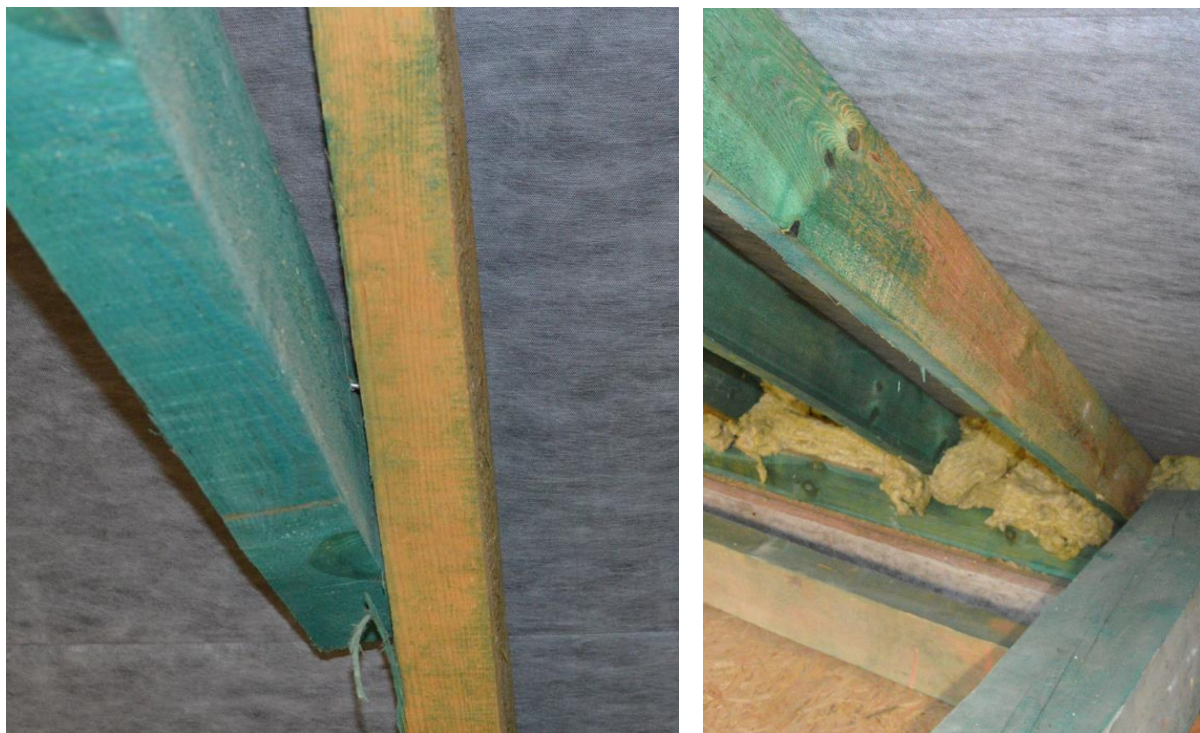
Płatew pośrednia - przekrój o krawędzi zaokrąglonej: nieprawidłowe przygotowanie elementu do wbudowania w obiekcie budowlanym [1.3]
